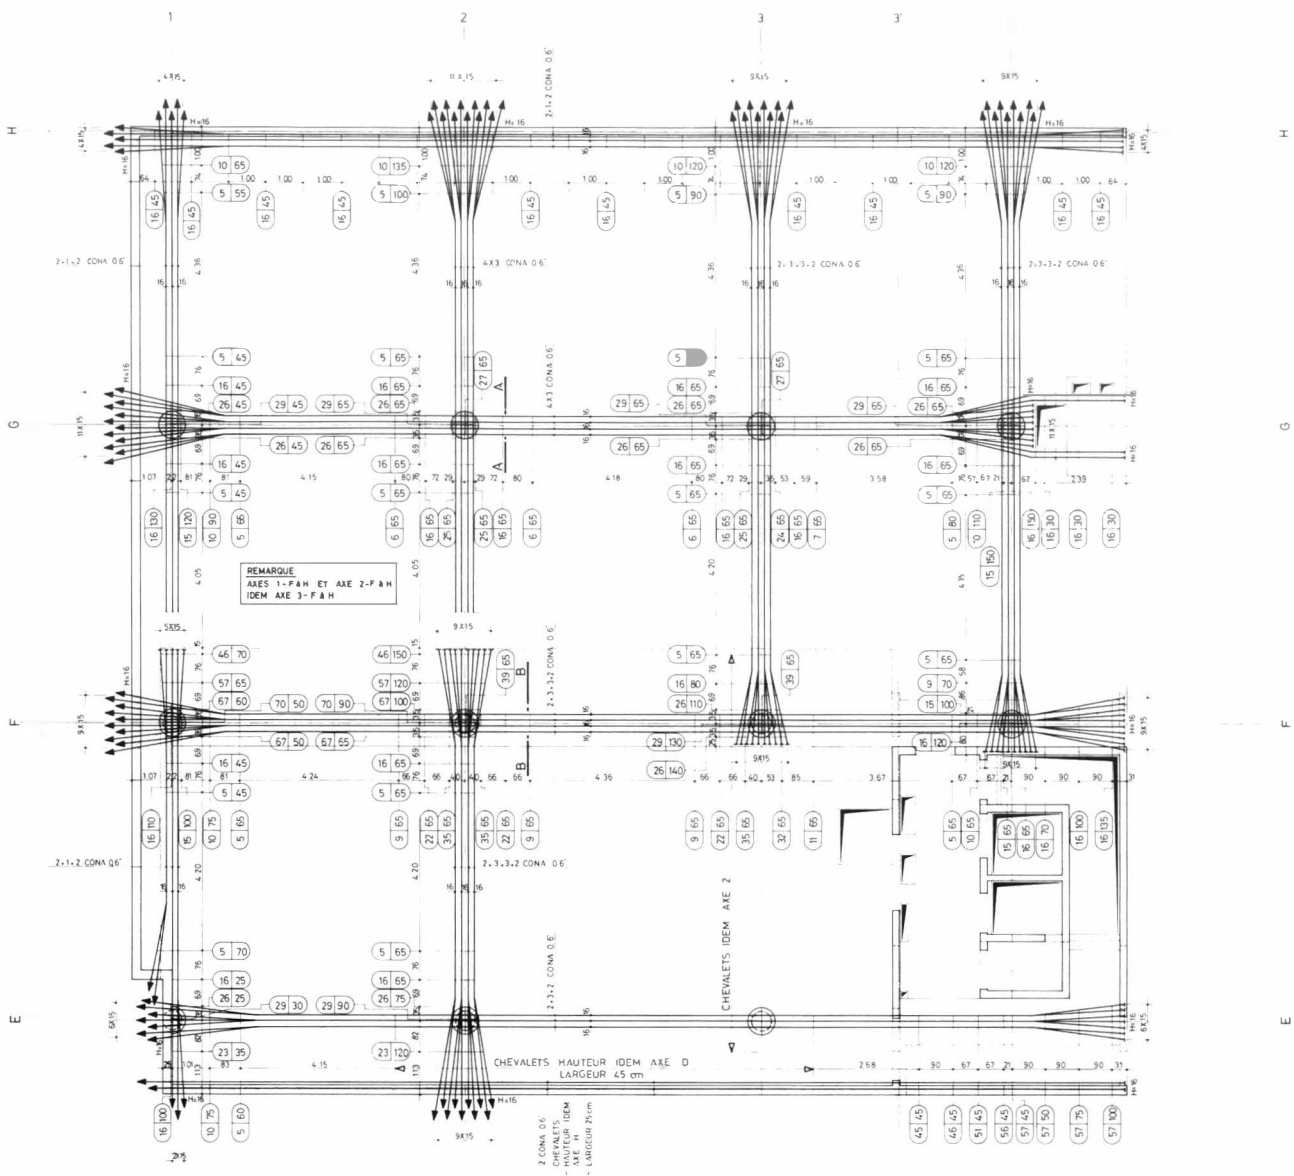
Block A. Dalle über Niveau 1. Grundriss und Kabelplan – Block A. Dalle sur niveau 1. Vue en plan et câblage – Block A. Slab over level 1. Plan and disposition of the prestressing cables
